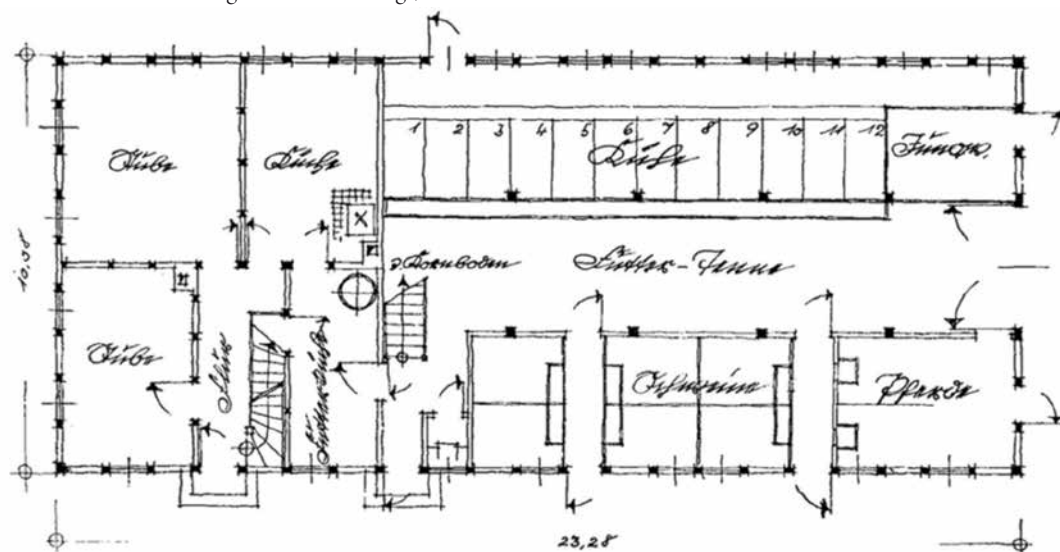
Grundriss Neubauernhof „Typ Neuhaus“, 1937; swv.
